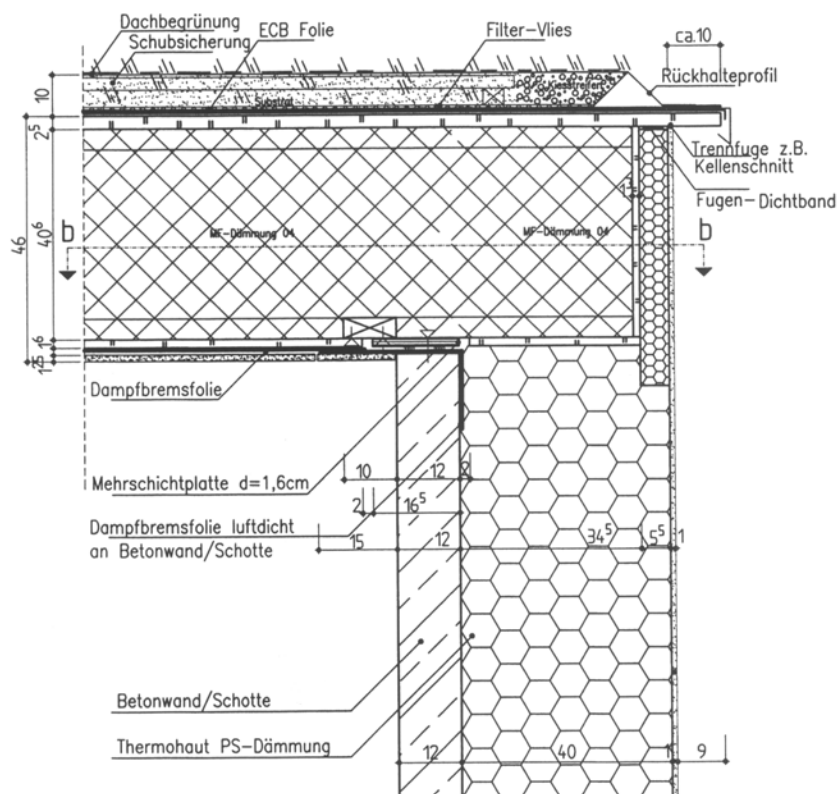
Wärmebrückenfreier Anschluß Wärmedämmverbundsystem der Giebelwand an das Leichtbau-Dachelement
